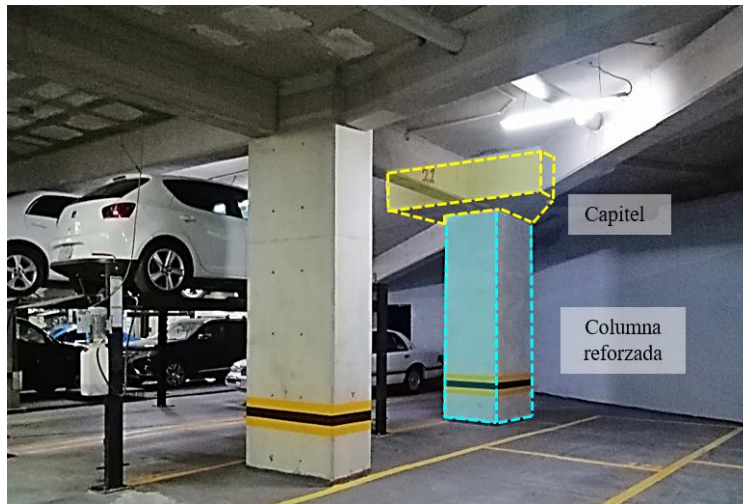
Capitel de refuerzo en columna, nivel sótano 1.
